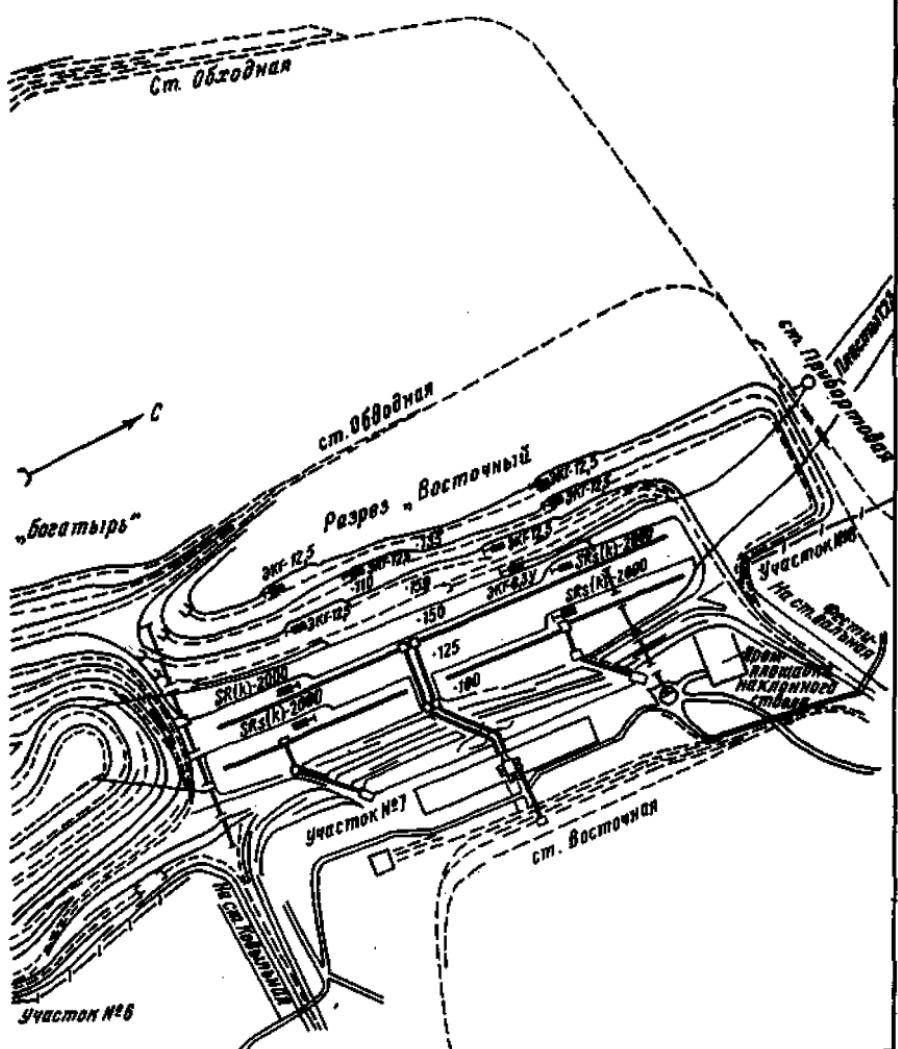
Схема горных работ разрезов южной группы на первом этапе реконструкции
